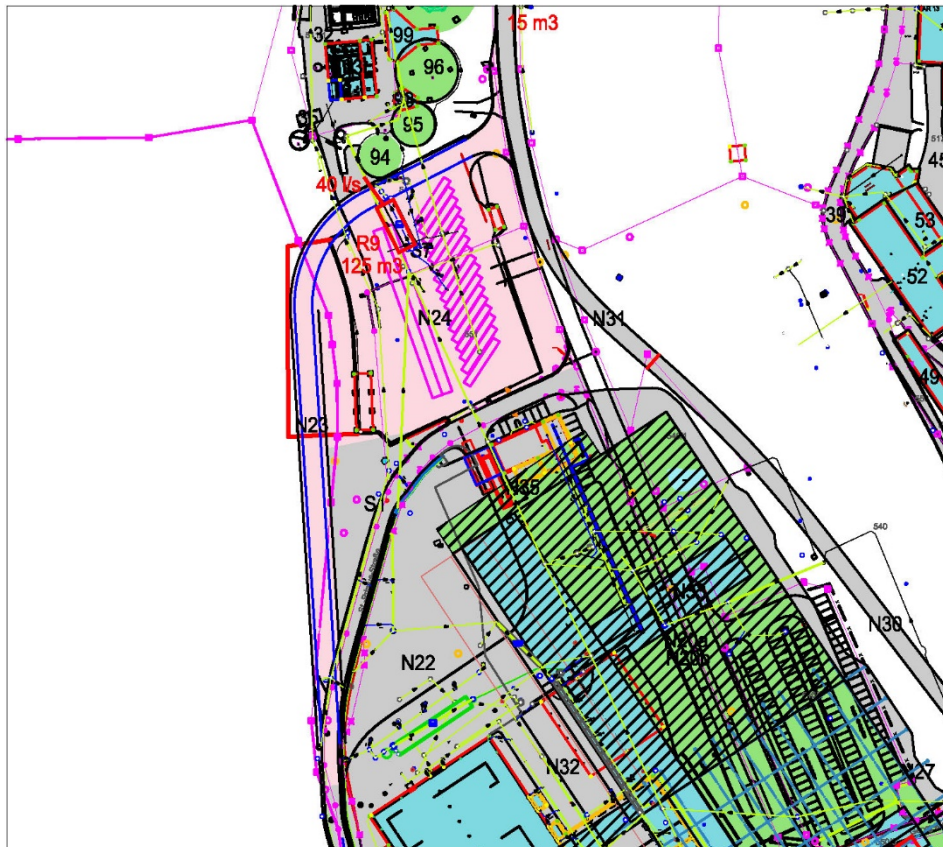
Flächenanteil für R9 – Rückhaltebecken bei Lkw-Aufstellfläche mit Ableitung in Schlagbach
